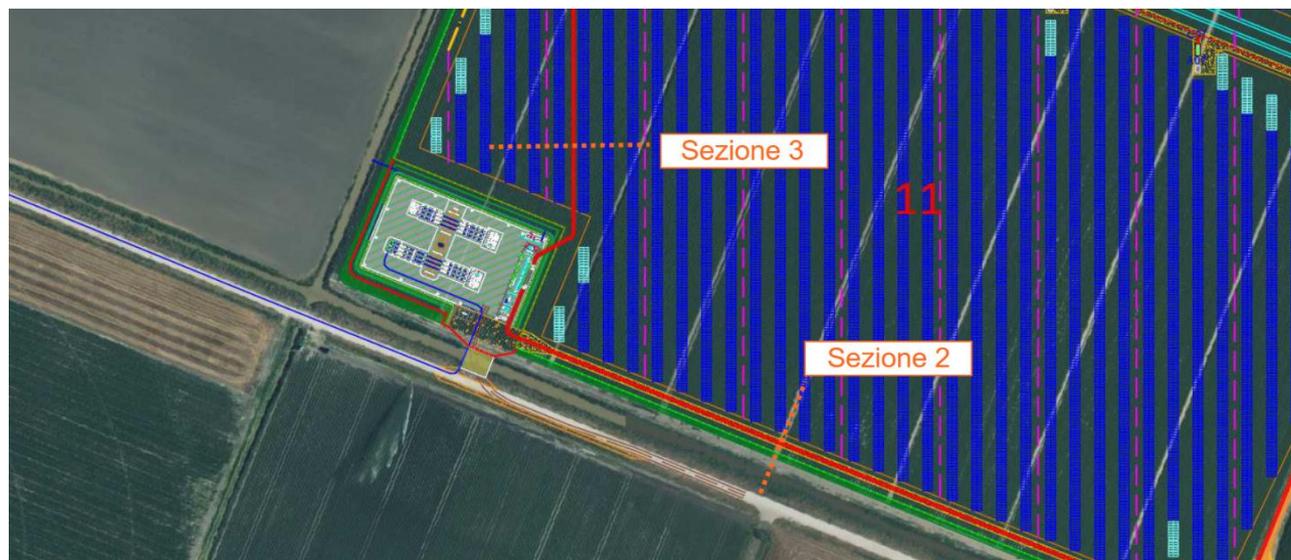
Dettaglio Sezione 2 e 3: Linee 30 kV dal Campo Agrivoltaico alla Stazione Utente
